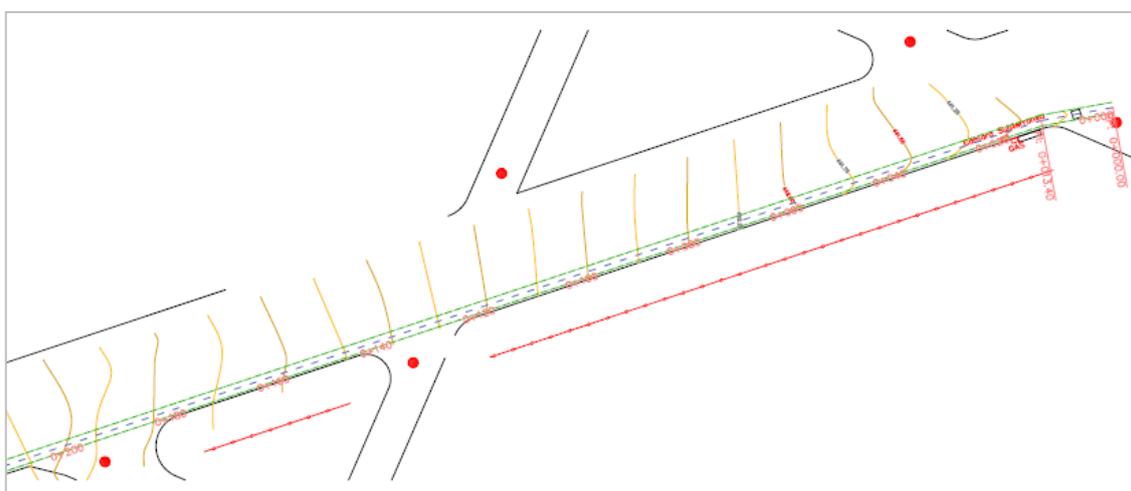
Levantamiento y Relevamiento Yrigoyen Norte - 2
